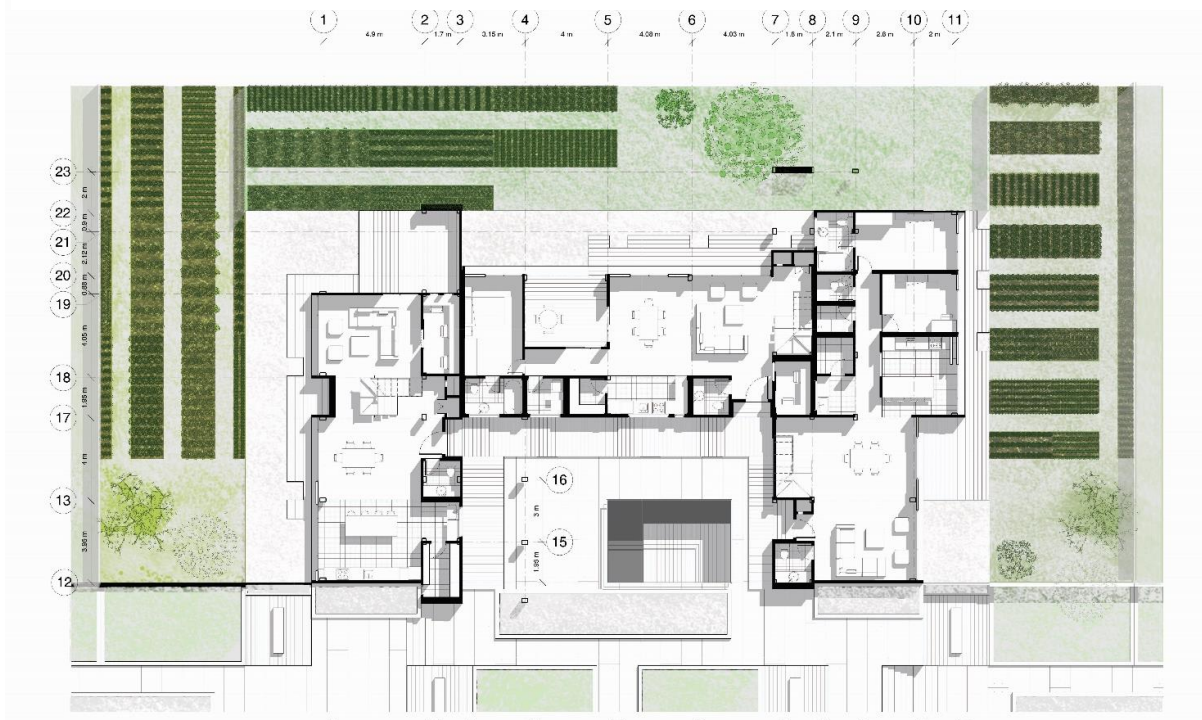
Planta baja de clúster resuelto. Elaboración Propia.
